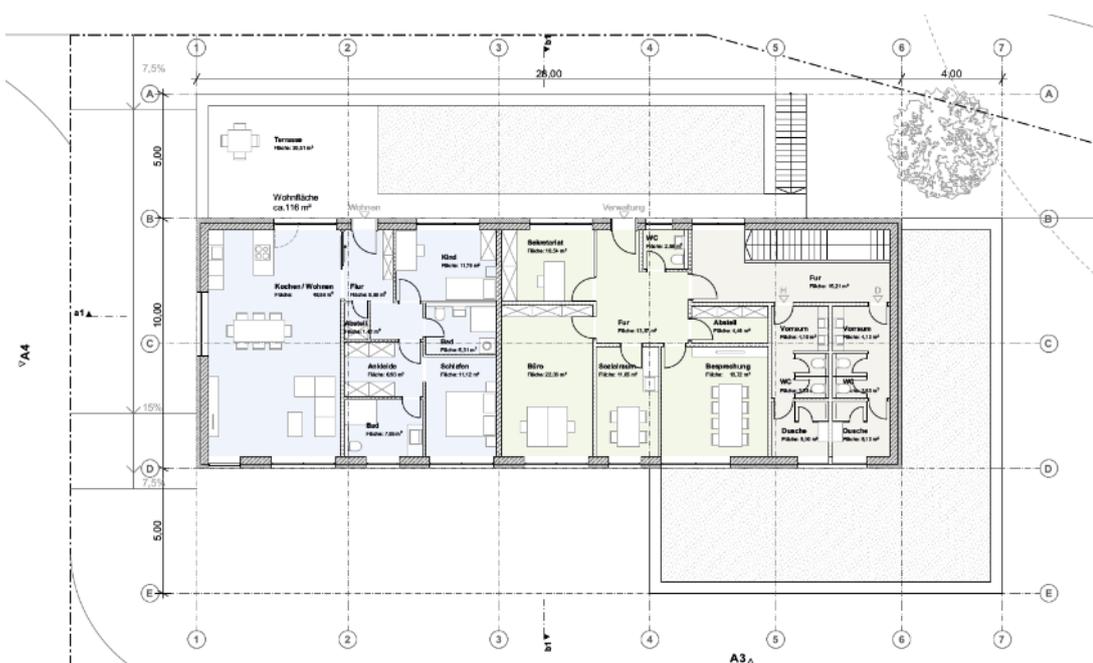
Grundriss OG (Schaack + Schank Architekten, Stand: 08.05.2023)
